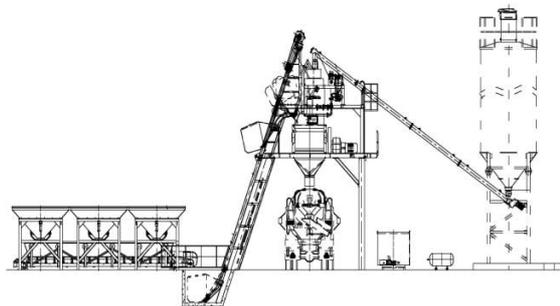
Planta de concreto premezclado, imagen ilustrativa
